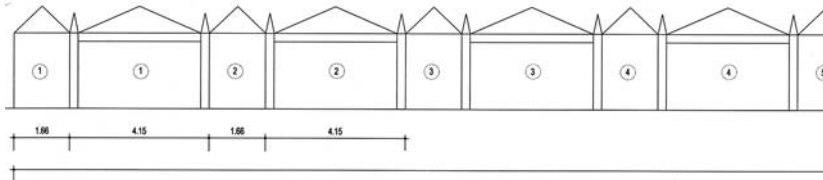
Reconstrucción de los Casamentos de la calle Sierpes. Detalle.
